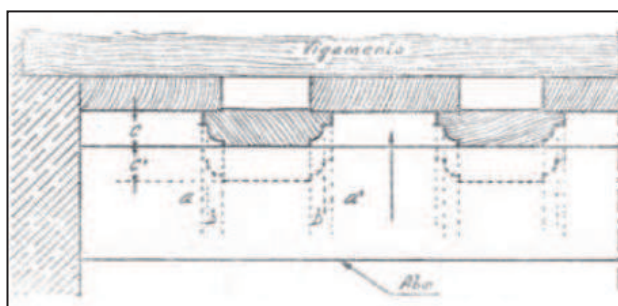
Corte de pormenor da execução do forro sobreposto [Costa, 1955].
